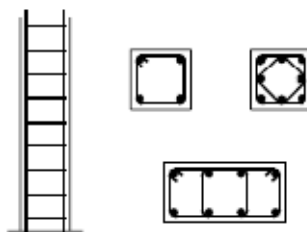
Ilustração de diferentes tipos de armaduras em pilares
